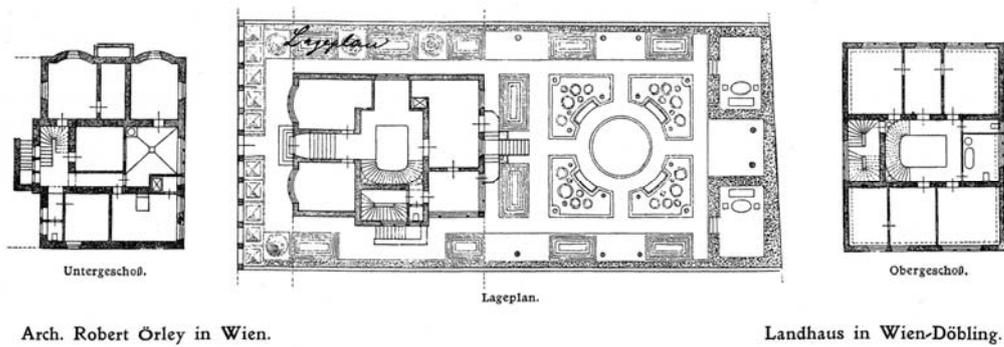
Villa Örley. Grundrisse und Gartenplan. 1906.
